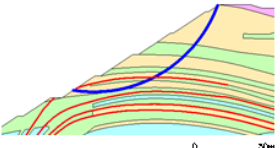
解析モデル図 (⑤-⑤' 断面)
